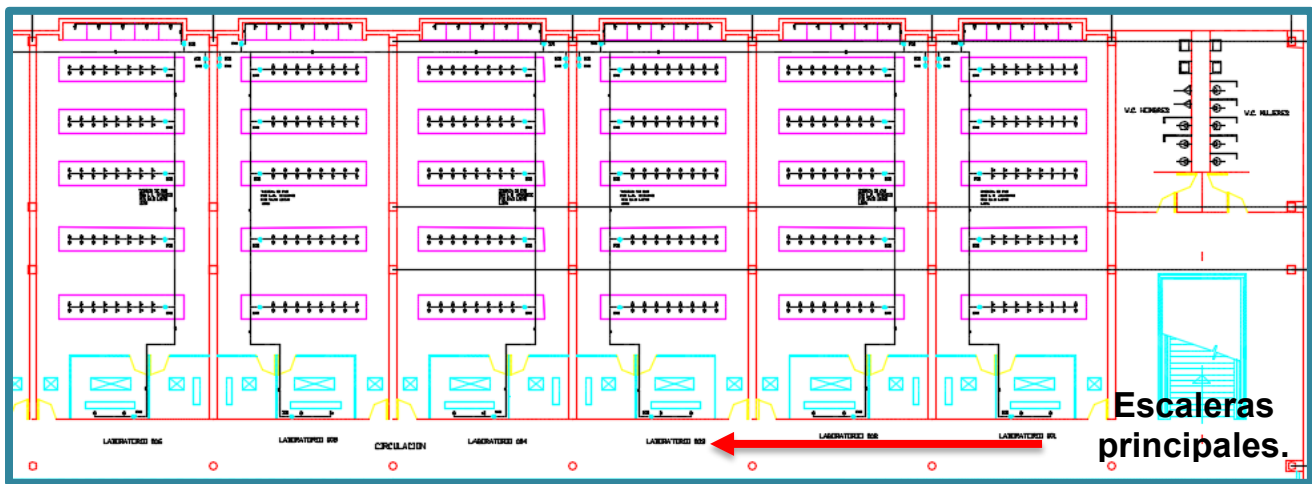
Distribución de los laboratorios en la primera planta del edificio C.
